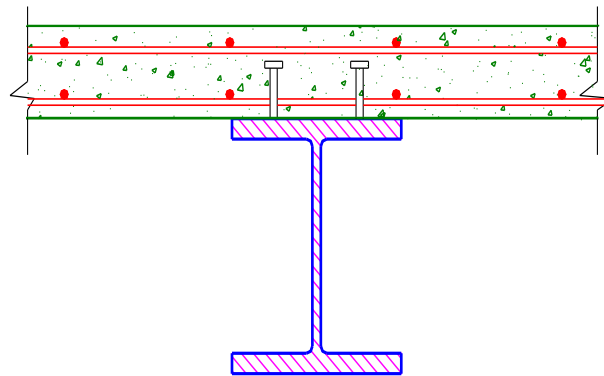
Esquema de una viga compuesta con conectores de corte.
